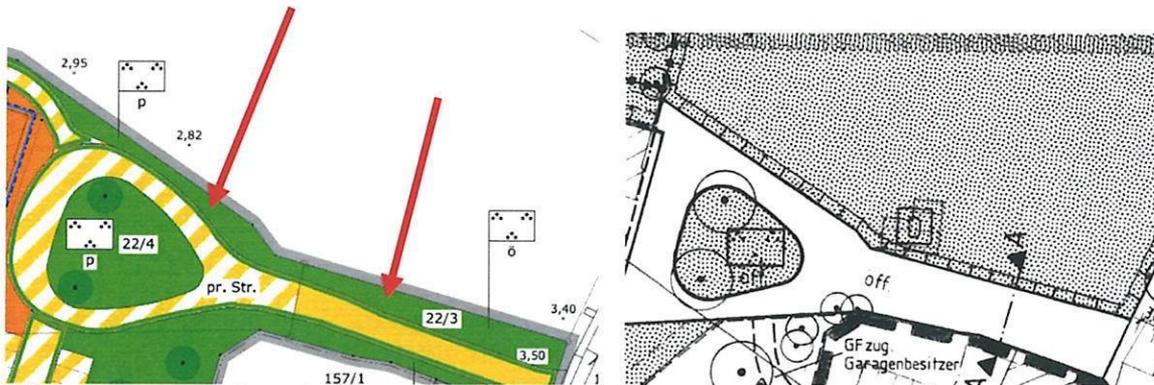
& 7: Auszug Planzeichnung (Stand: 5. April 2023) und Ursprungsplan
